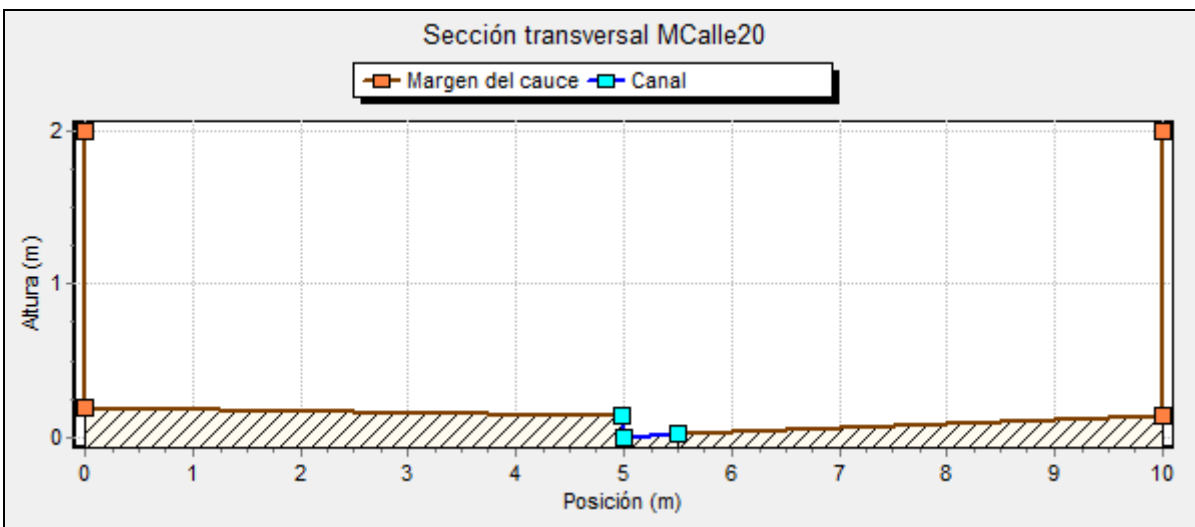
Sección transversal de media calle de 20m de ancho, con cunetas de hormigón y calzadas de empedrado o pavimento flexible.
